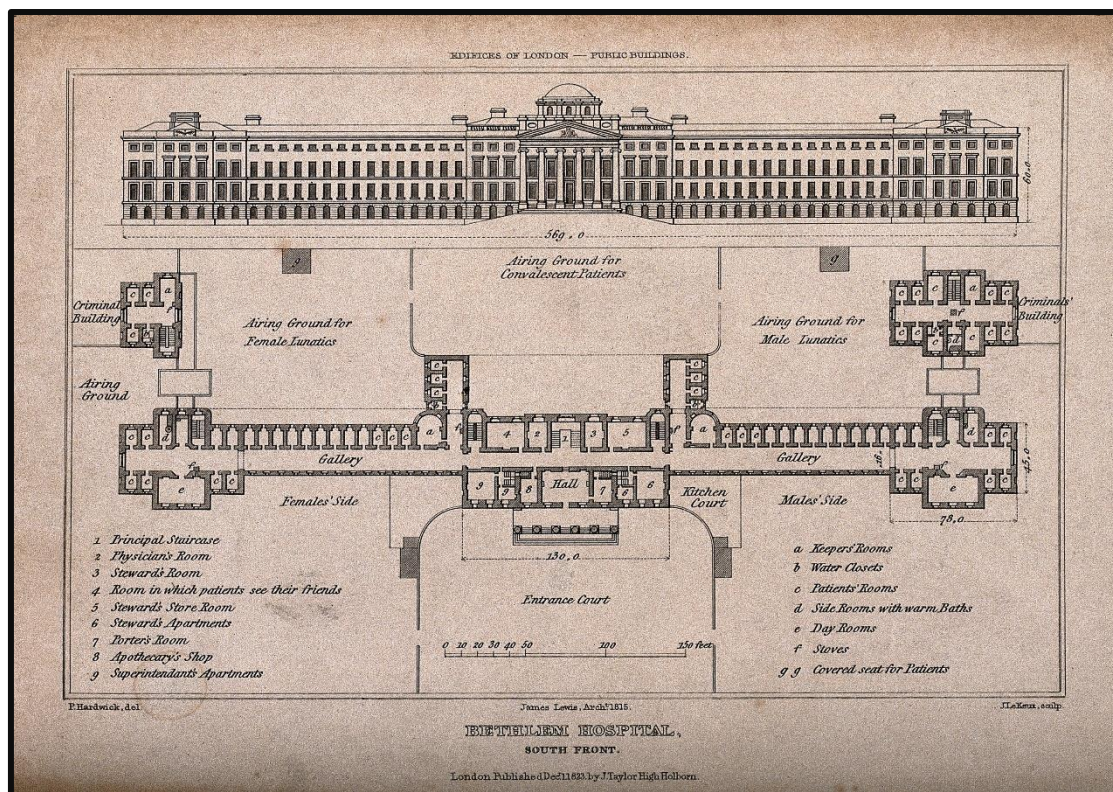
Elevación y Planta del nuevo Hospital Bethlehem en Moorfields
